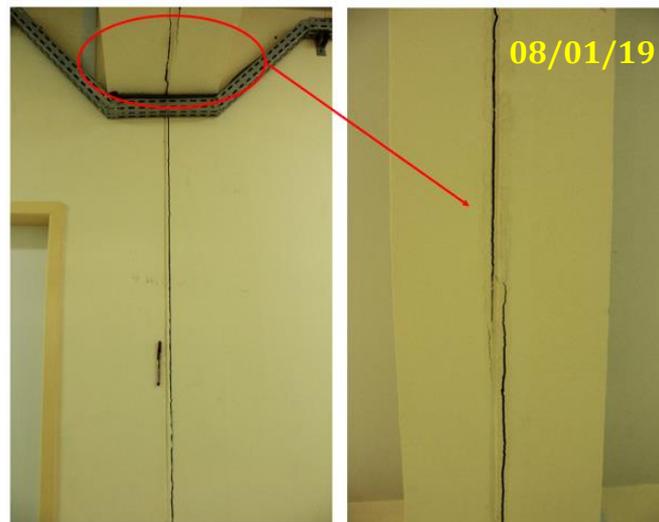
Fissuras nas juntas de dilatação, Bloco VII/UFRR, campus Paricarana.
